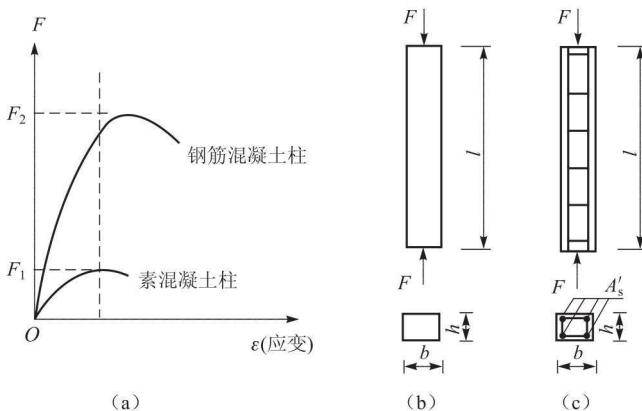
素混凝土和钢筋混凝土轴心受压构件的受力性能比较
